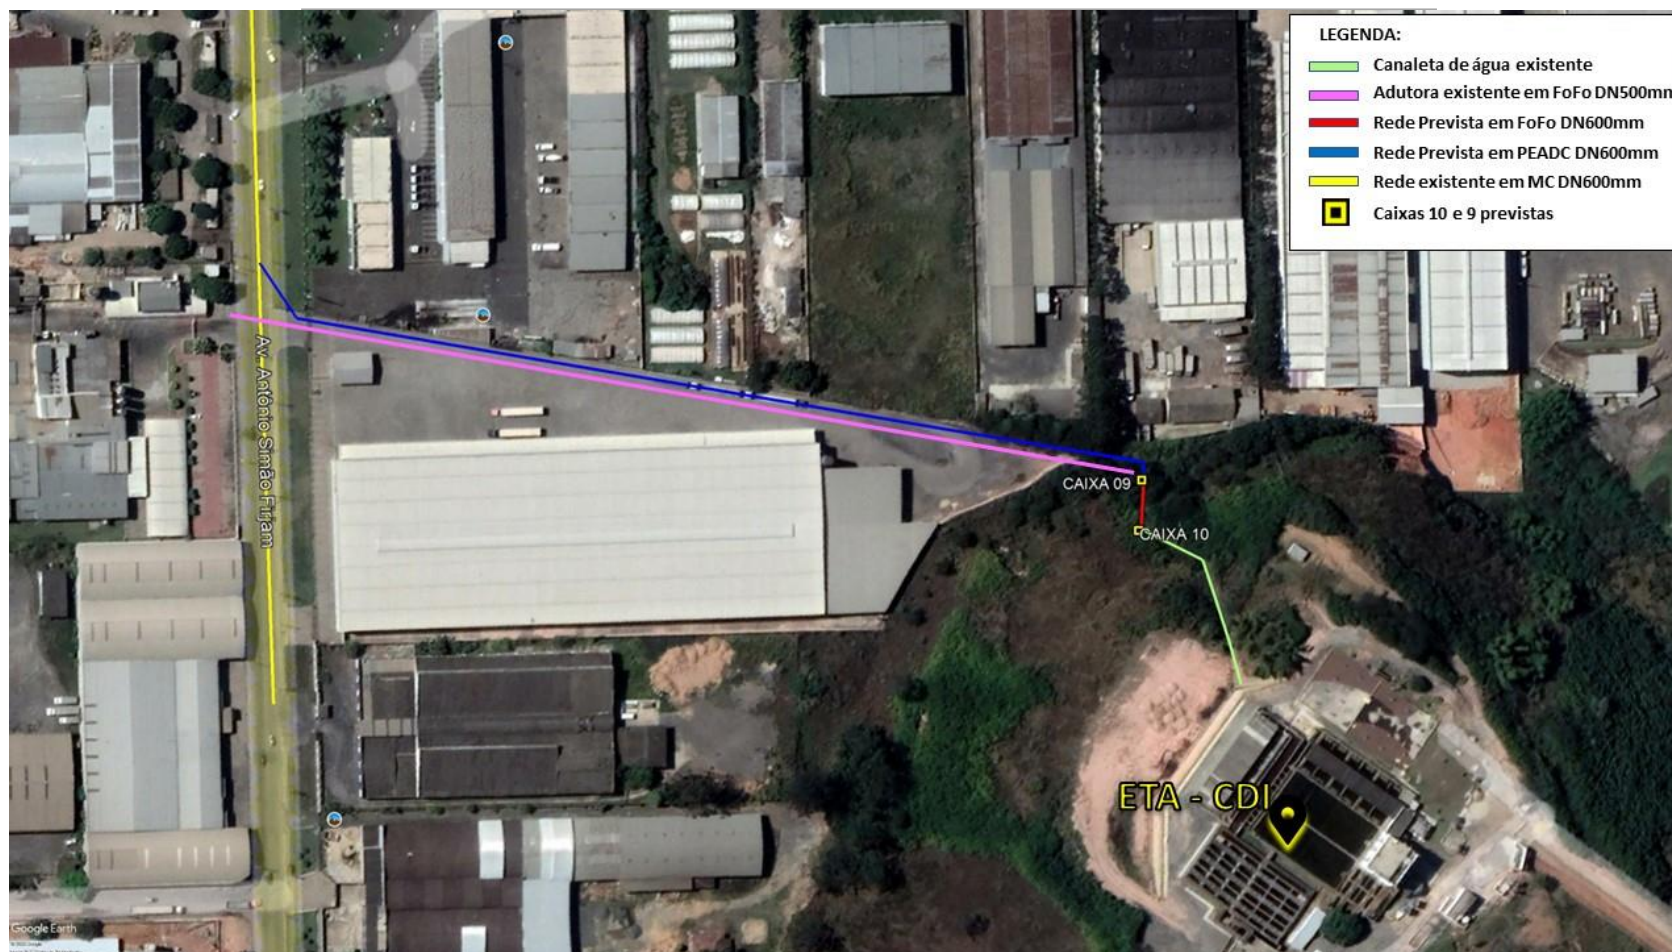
Traçado Rede de Drenagem – ETA-CDI
